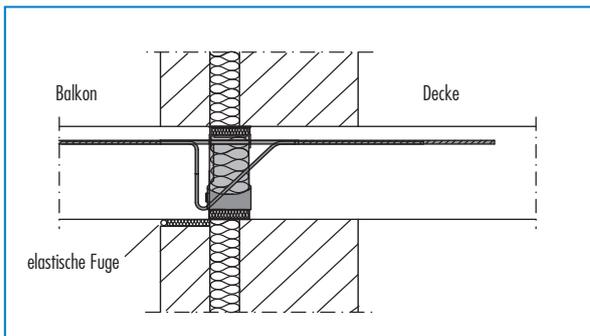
Zweischaliges Mauerwerk bei deckengleichem Balkon
